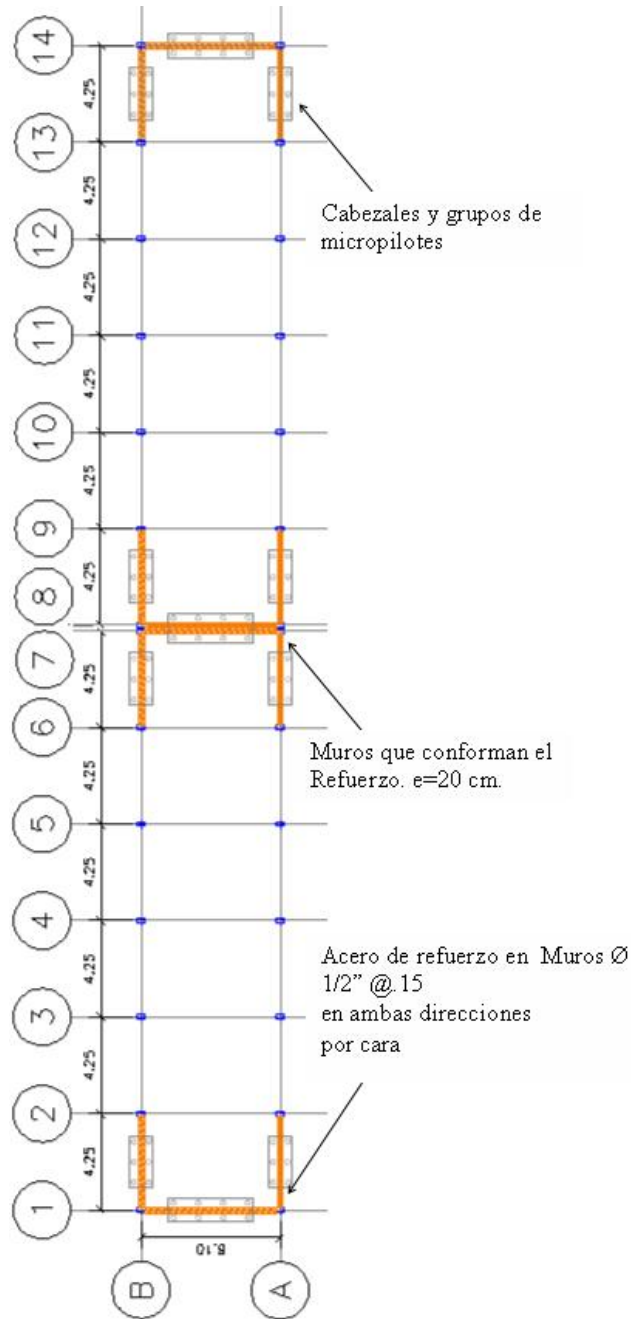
Planta Nivel +0.00. Propuesta de Fundación
